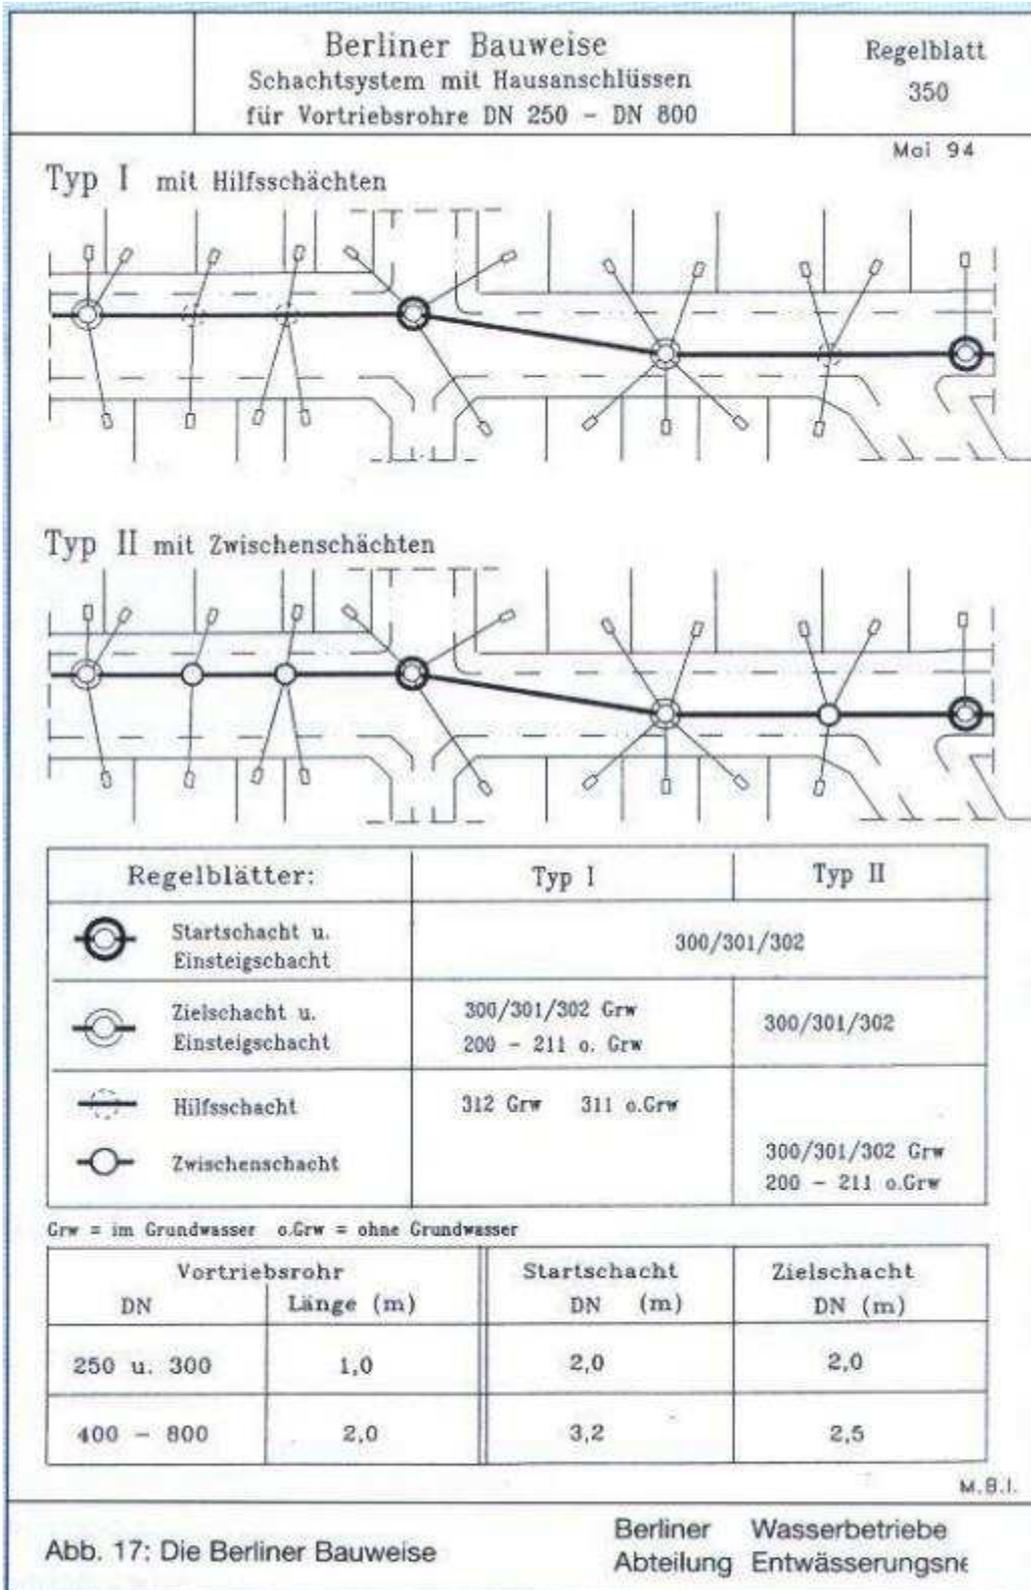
Berliner Bauweise - Schachtsystem mit Hausanschlüssen für Vortriebsrohre DN 250 - DN 800
